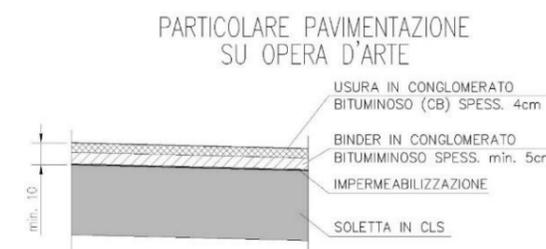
Dettaglio pavimentazione su opera d'arte
